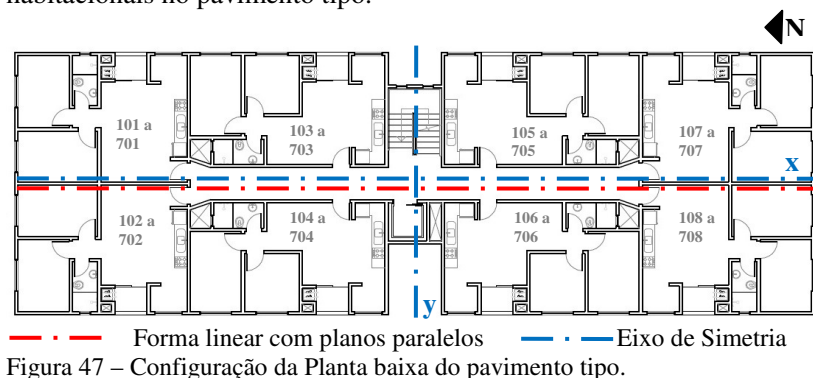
Configuração da Planta baixa do pavimento tipo.
